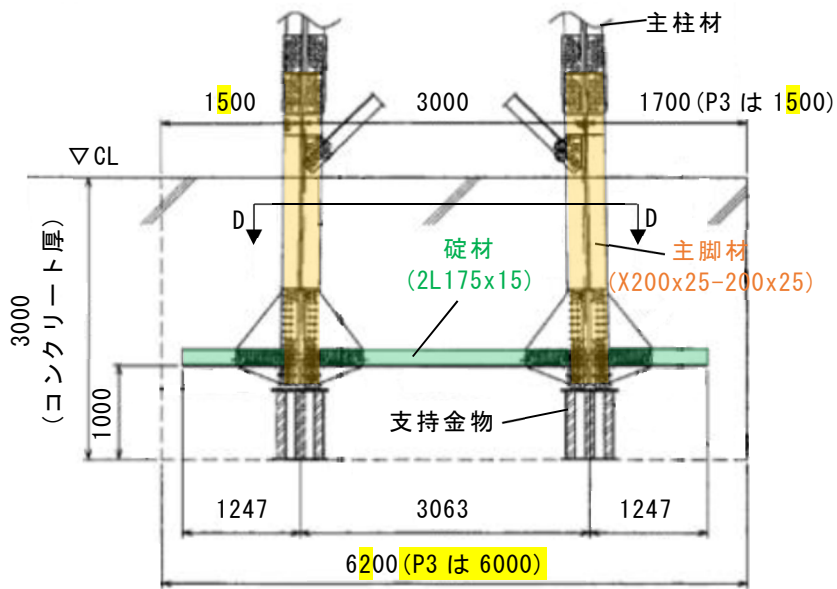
基礎コンクリート内の主脚材及び碇材の平面配置図
